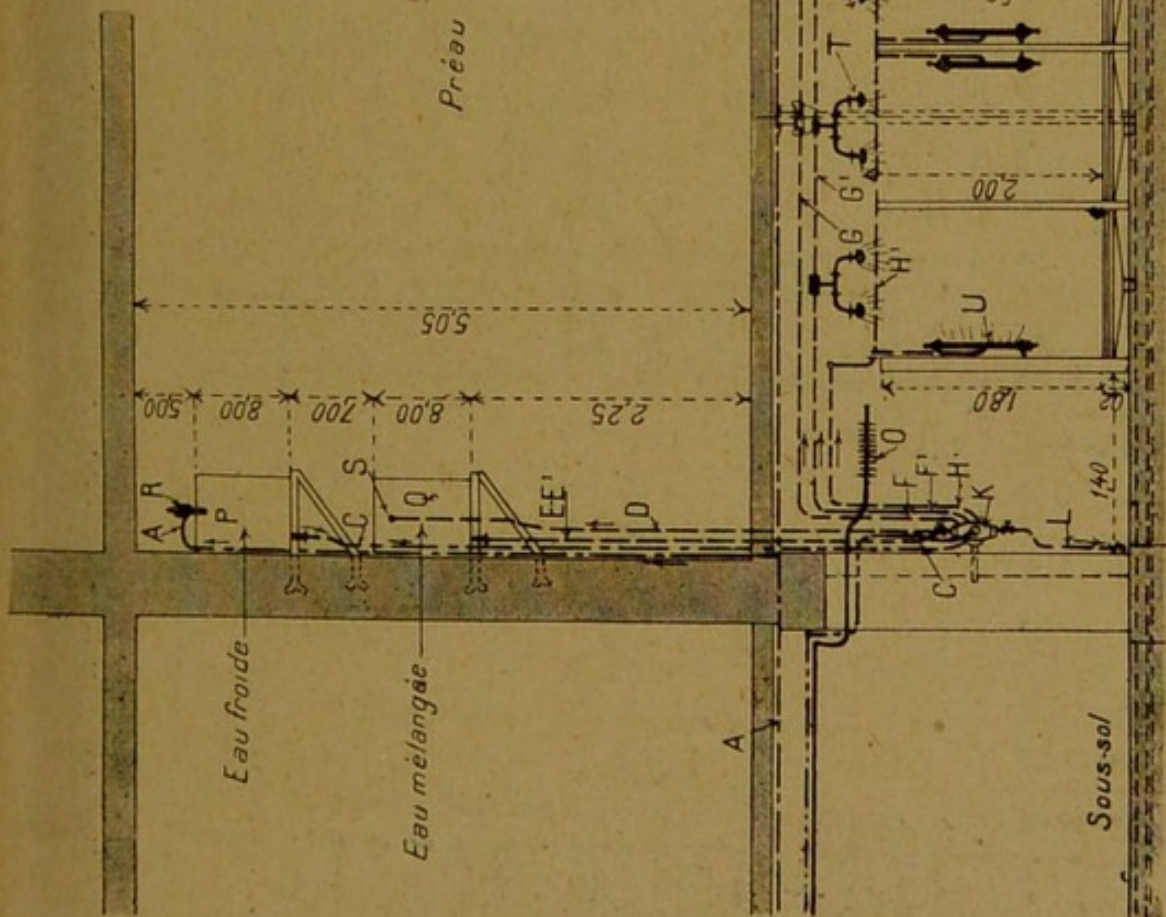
Coupe en hauteur de l'installation des bains-douches du lycée de Grenoble montrant la disposition des appareils.
